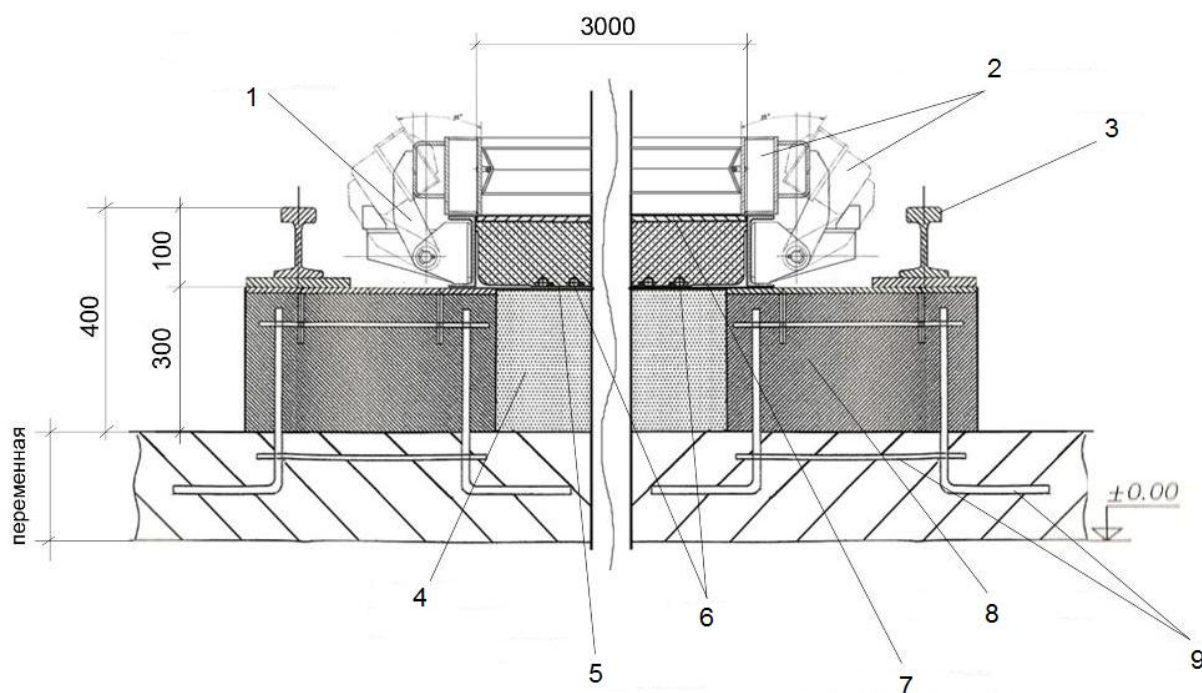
Узлы и детали стендовой линии «СЛ-7» для формовки плит перекрытия строительной системы «КУБ-3V».
